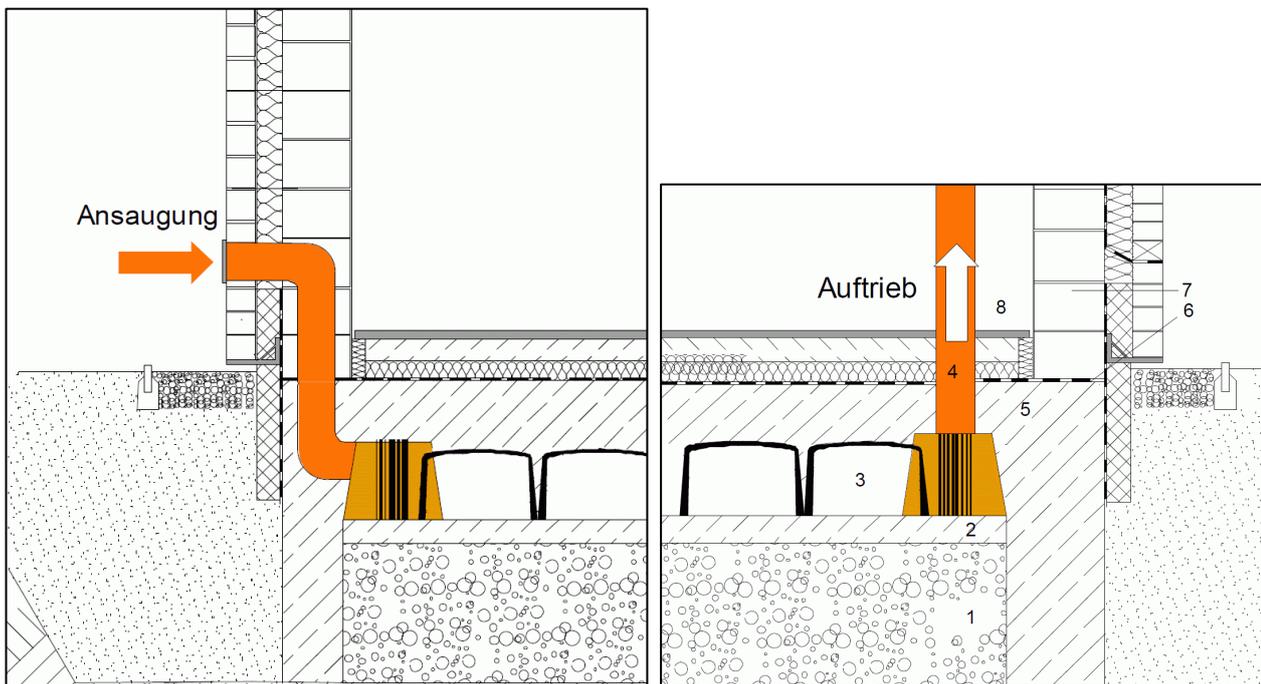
Vertikalschnitt durch Hohlraumelemente mit passiver Durchlüftung [13]
